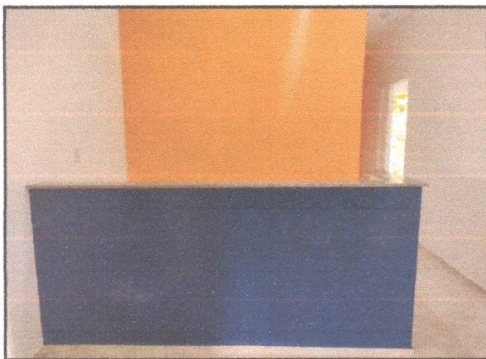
Vista da área para recepção, com destaque ao piso cerâmico.
